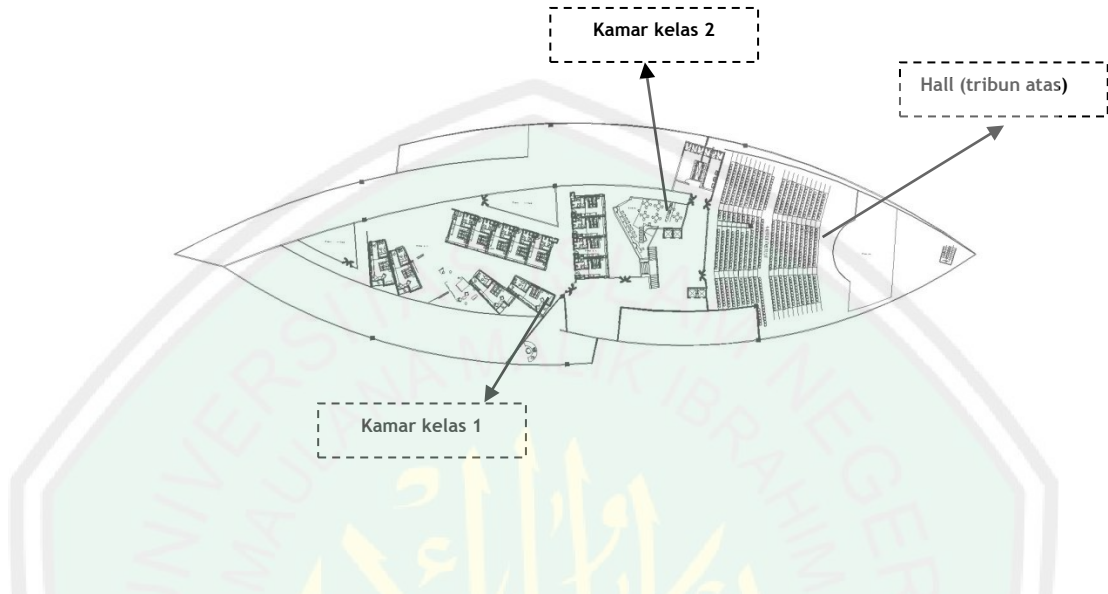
Denah lantai 1 Kantor dan Asrama
